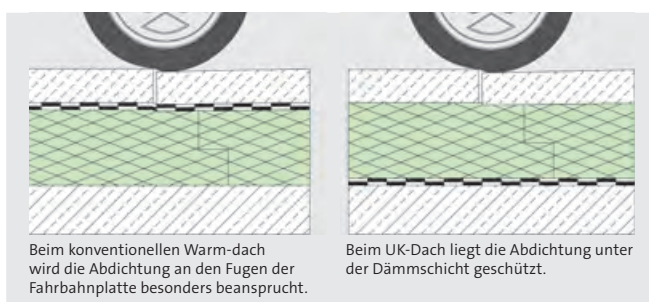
Parkdach als konventionelles Warmdach und als UK-Dach. Während die Dachabdichtung beim Warmdach gefährdet ist, liegt sie beim UK-Dach geschützt.
